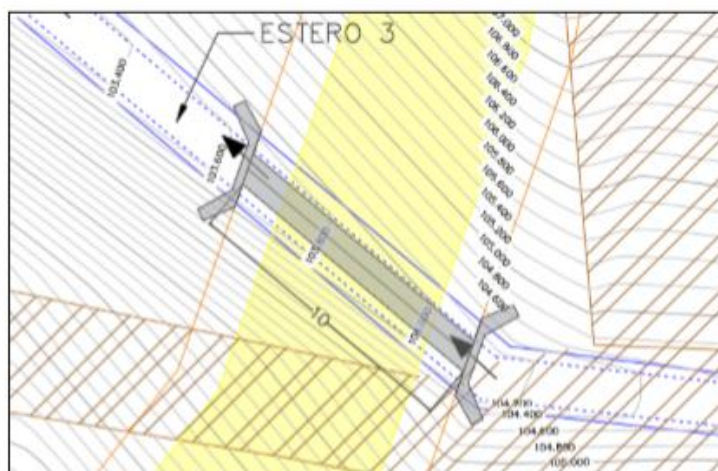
Imagen en planta de Atraveso Estero 3
